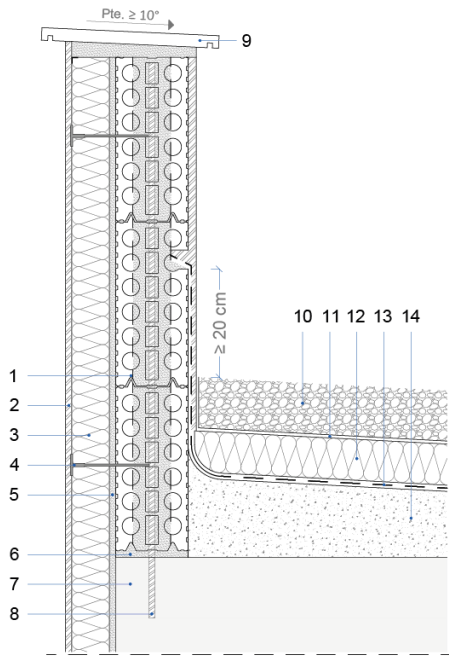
Fachada SATE. Encuentro con peto. Sección vertical.
